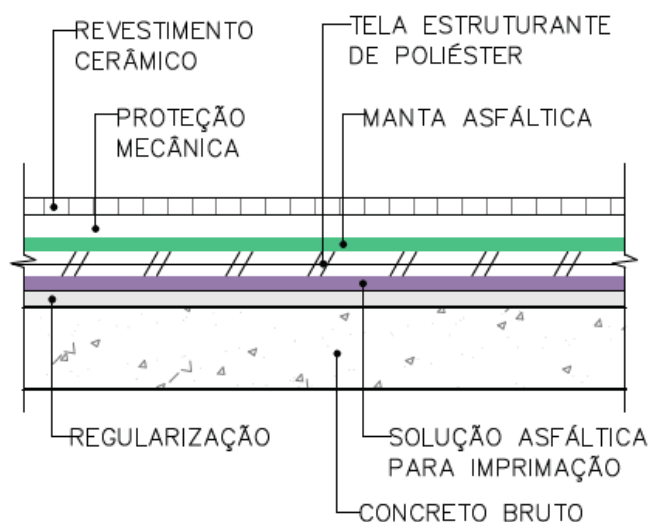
Sistema de impermeabilização banheiros, cozinha, lavanderia
